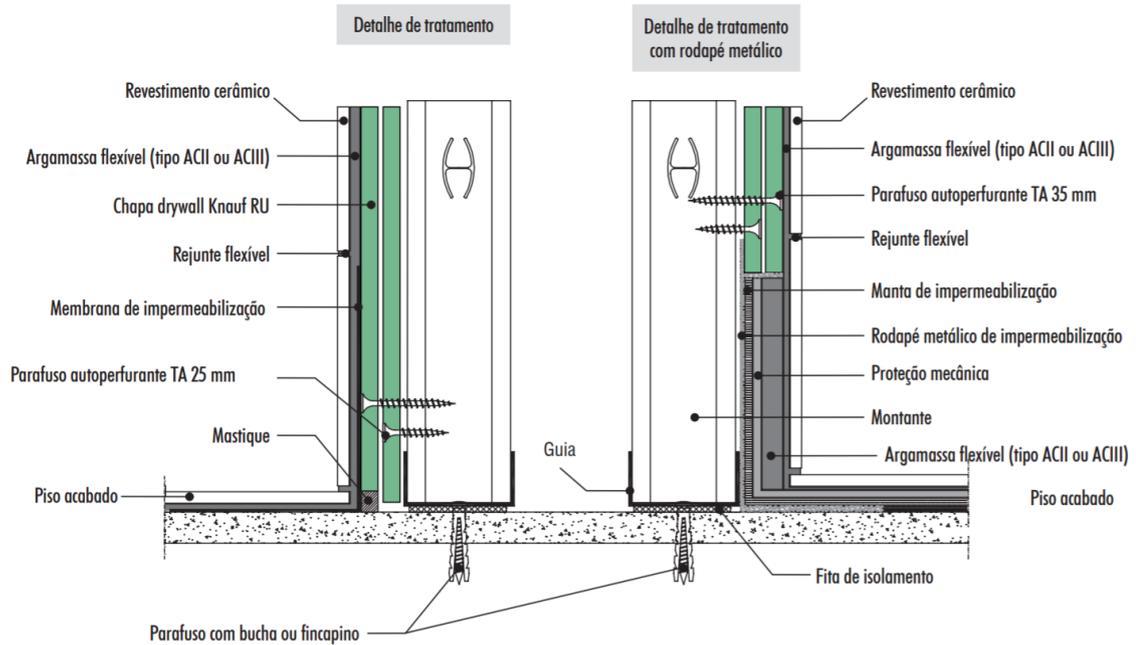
Drywall para banheiros conforme a Trevo (2017)
